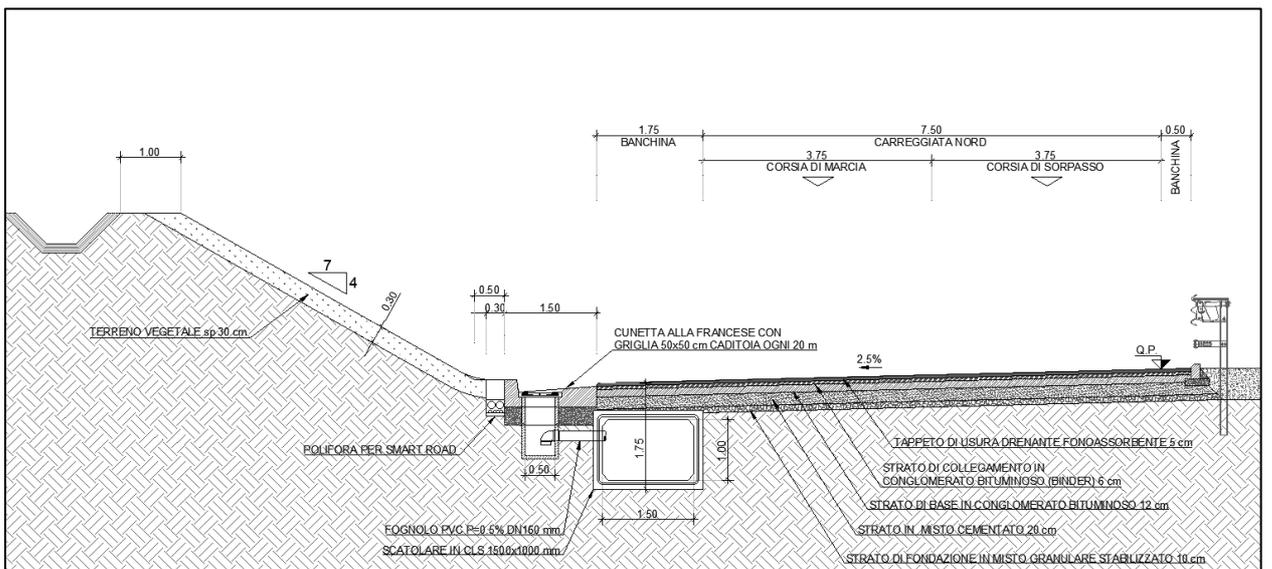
Dettaglio Sezione tipo trincea carreggiata nord
